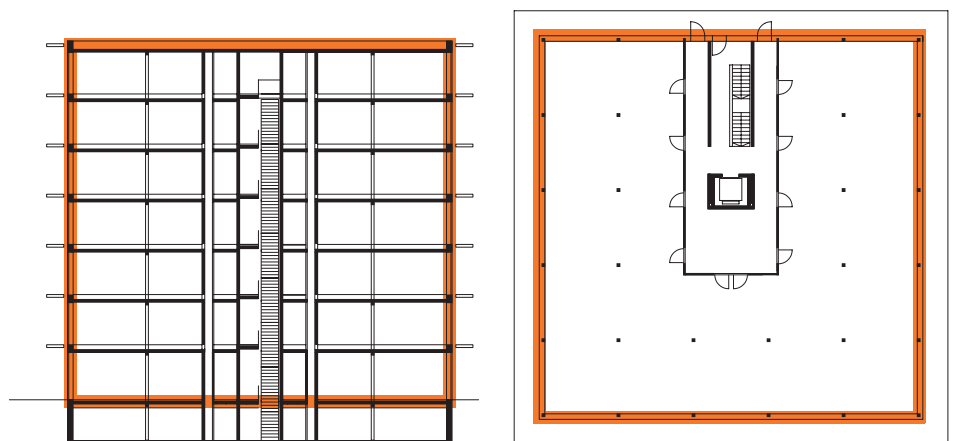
Schnitt und Grundriss: Eine durchgehende und hochwertige Dämmebene sowie ein kompakter Baukörper ermöglichen ein sehr niedrigen Energieverbrauch bezogen auf den Quadratmeter Nutzfläche.
